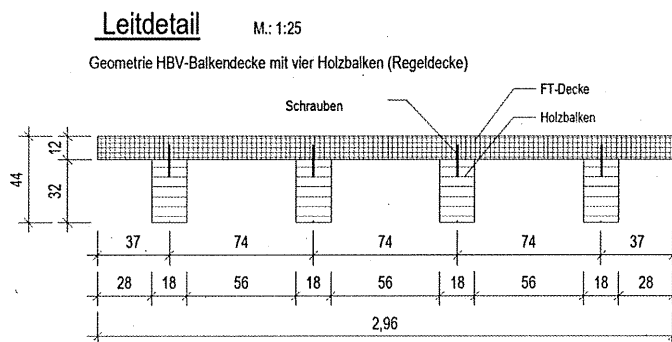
· Leitdetail HBV-Balkendecke (aus [1])
